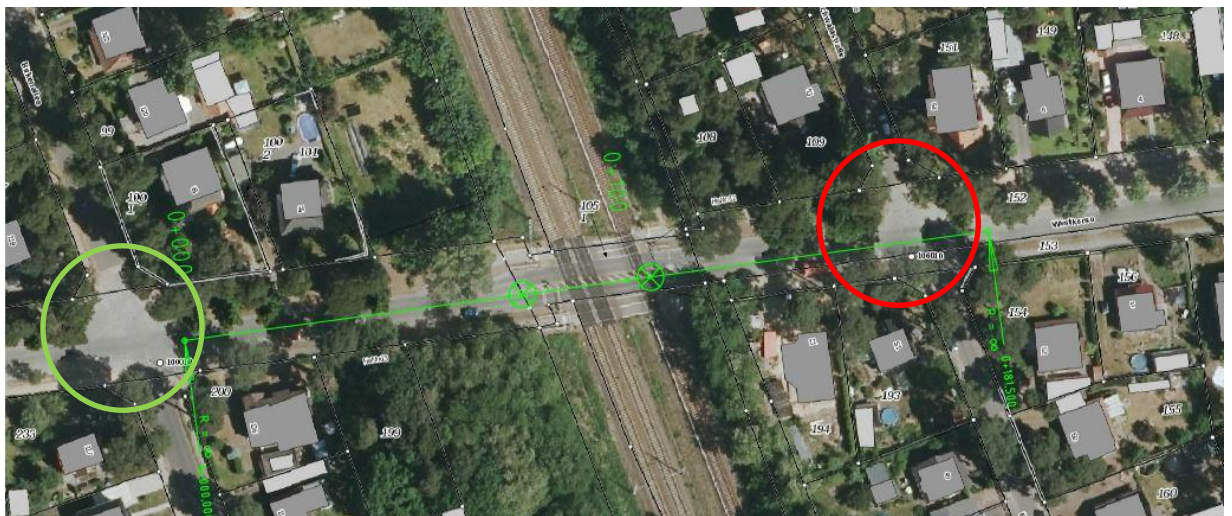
EÜ: Achse Westkorso mit Zwangspunkten Gleise (SO) im Lageplan (Quelle: Brandenburgviewer)
